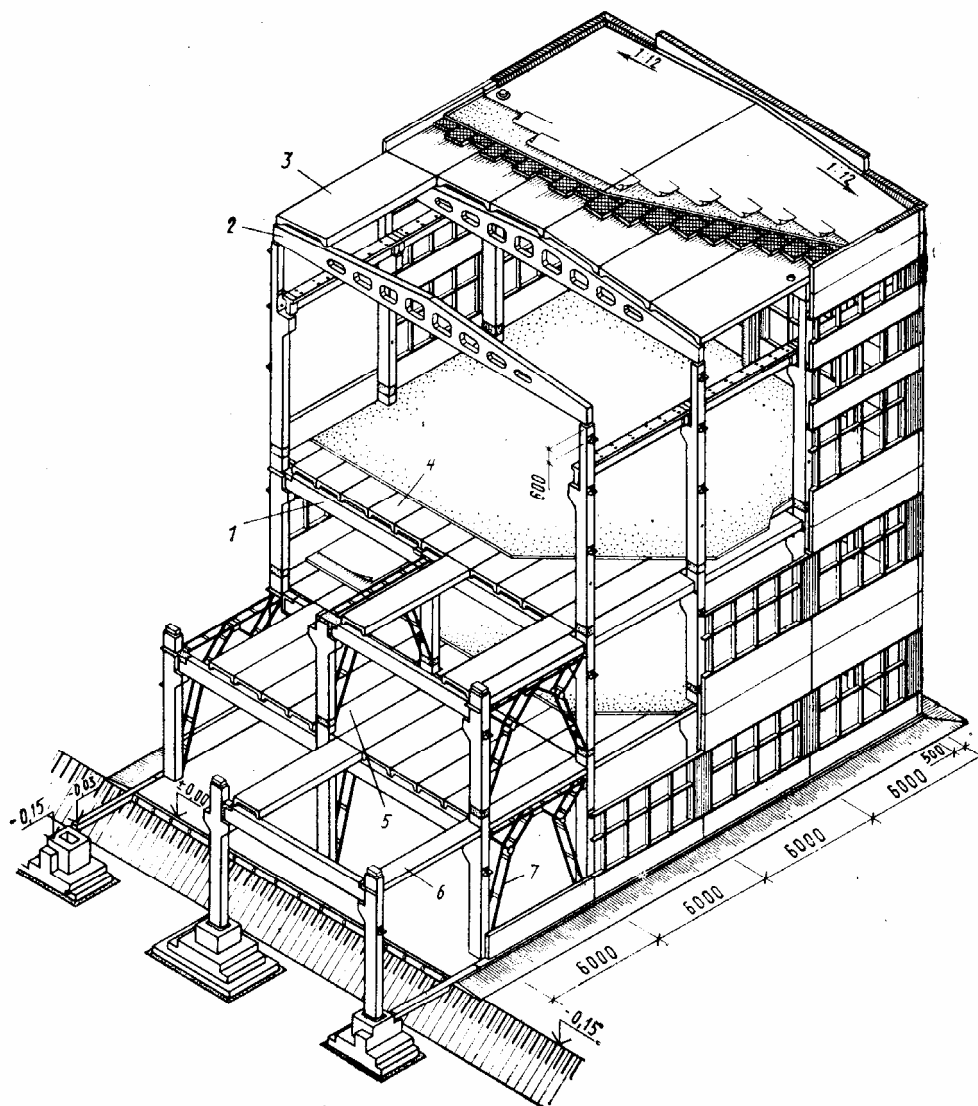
Многоэтажное производственное здание с балочным каркасом из сборных железобетонных конструкций
